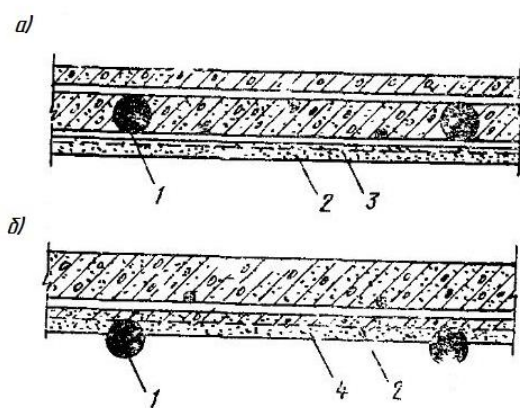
Сечения монолитных железобетонных висячих оболочек
